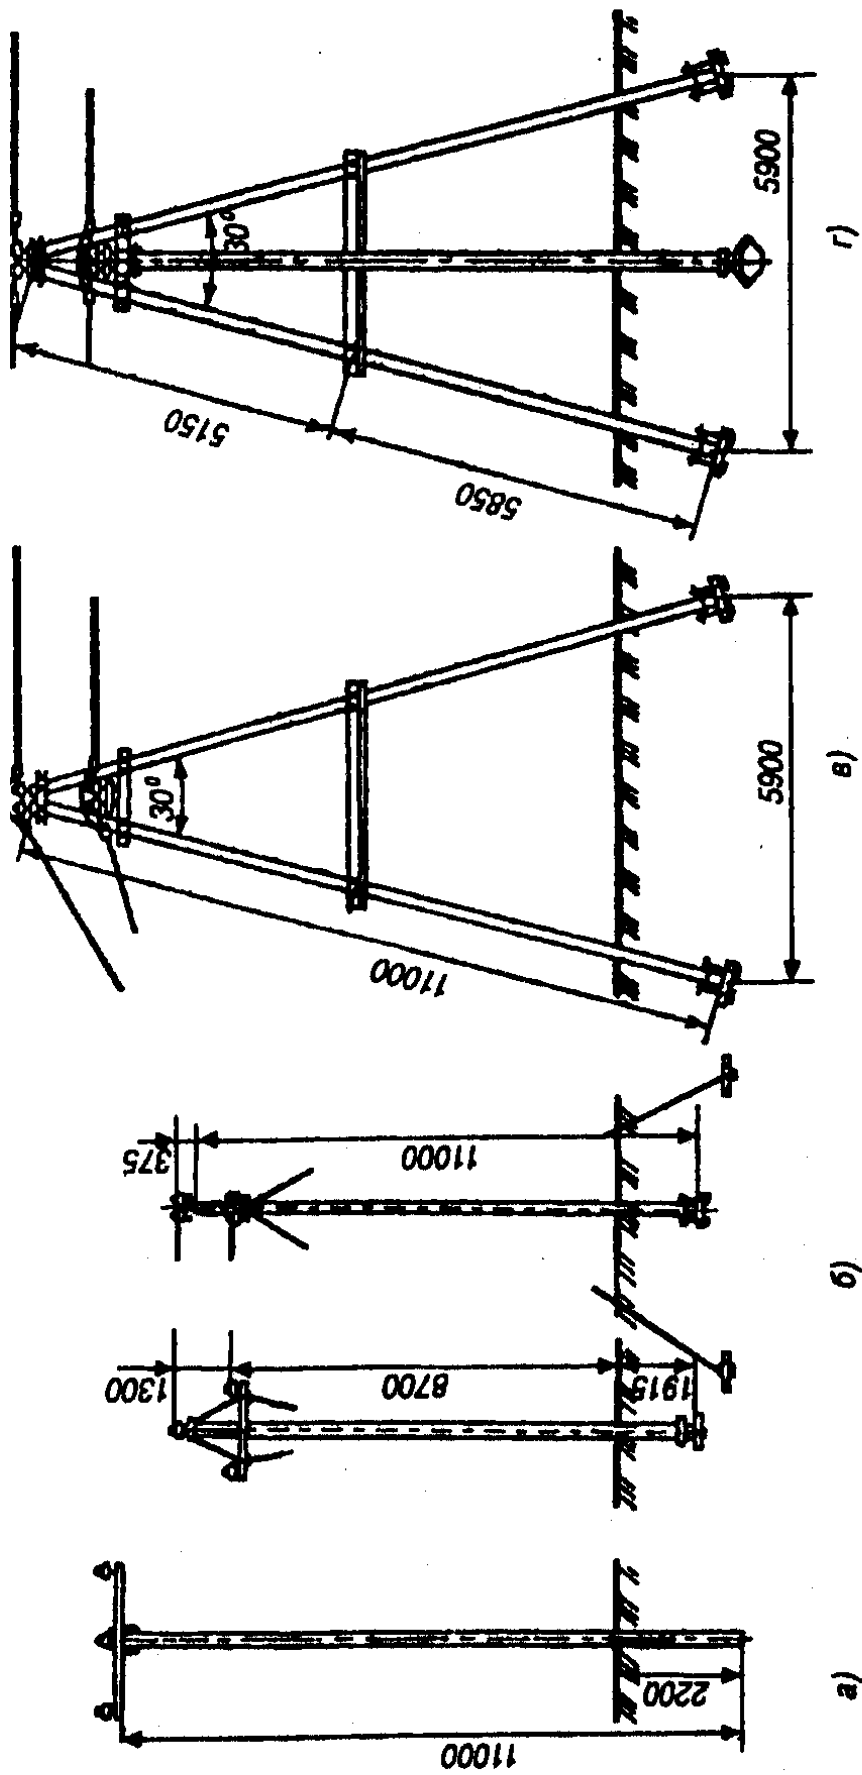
Железобетонные опоры ВЛ6—10 кВ:
